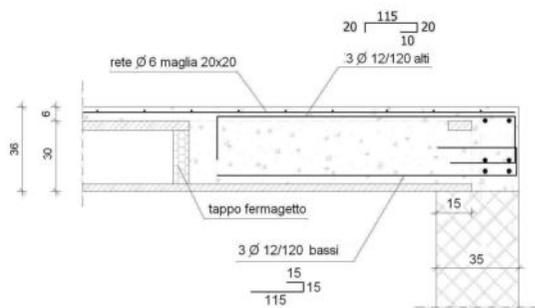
Esempio di collegamento con muratura laterale
